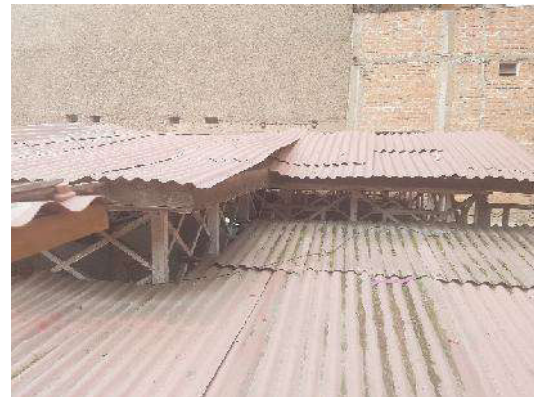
Imágenes que ejemplifican condición de Sistema Sanitario de Drenaje Pluvial
